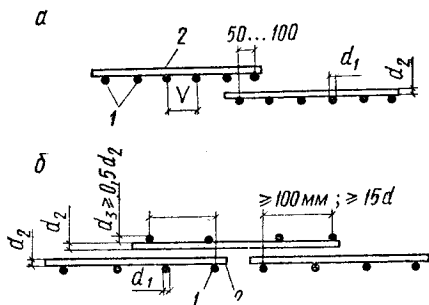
Стыки сварных сеток в направлении рабочей арматуры
